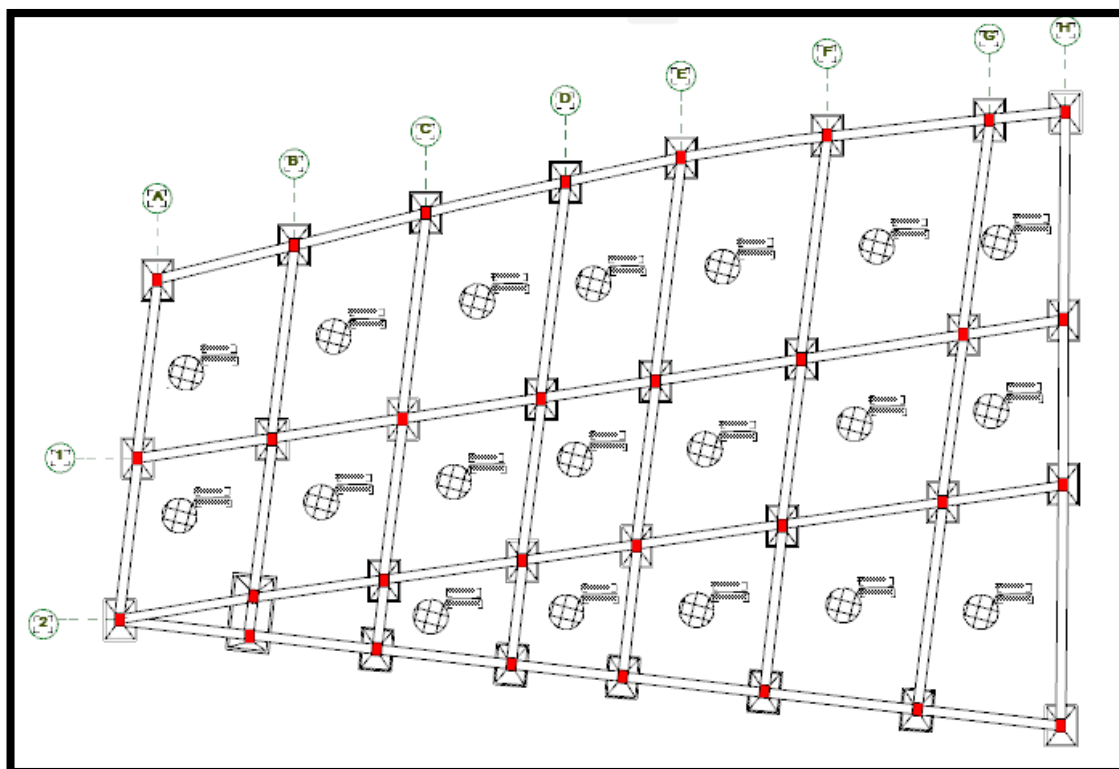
plan de fondation bloc 02 du musée Source : auteur
